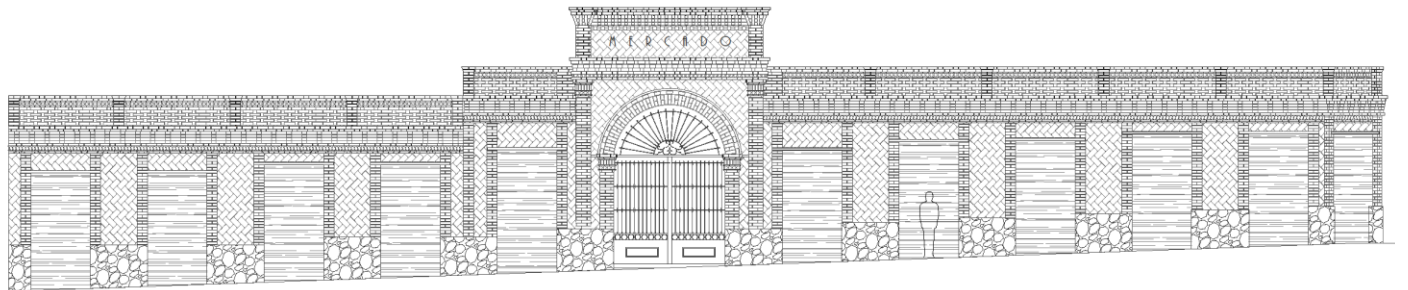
Fachada Oeste (Plaza de la Constitución)
